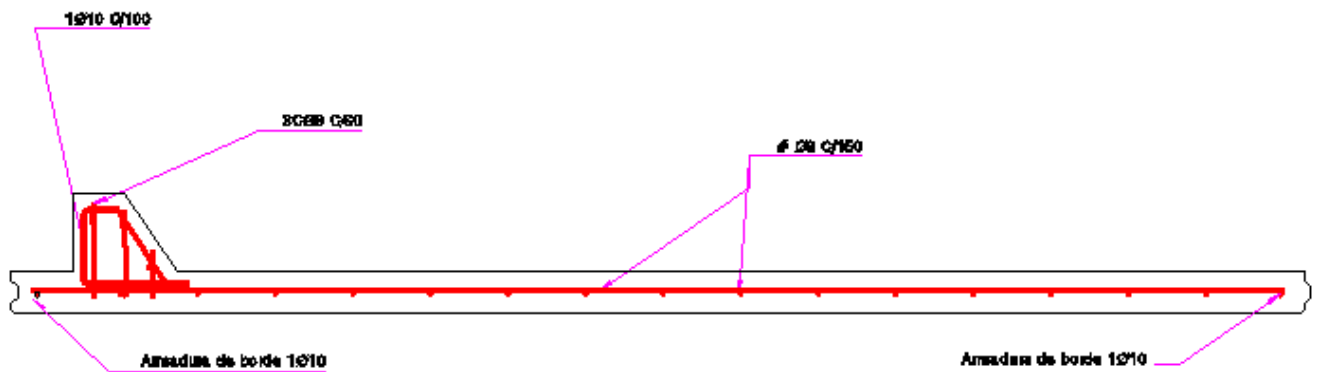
Sección vertical del panel prefabricado con ménsula y detalle de su armado
